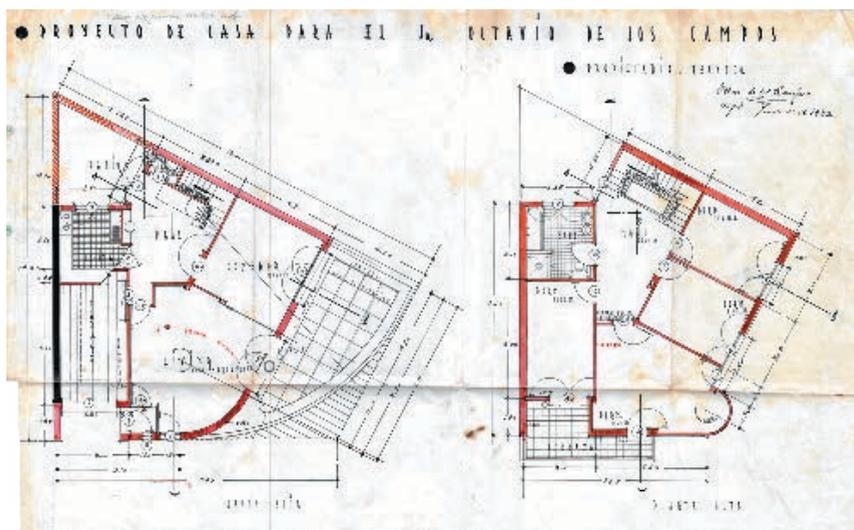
CASA DE LOS CAMPOS. PLANTA BAJA Y PLANTA ALTA.
